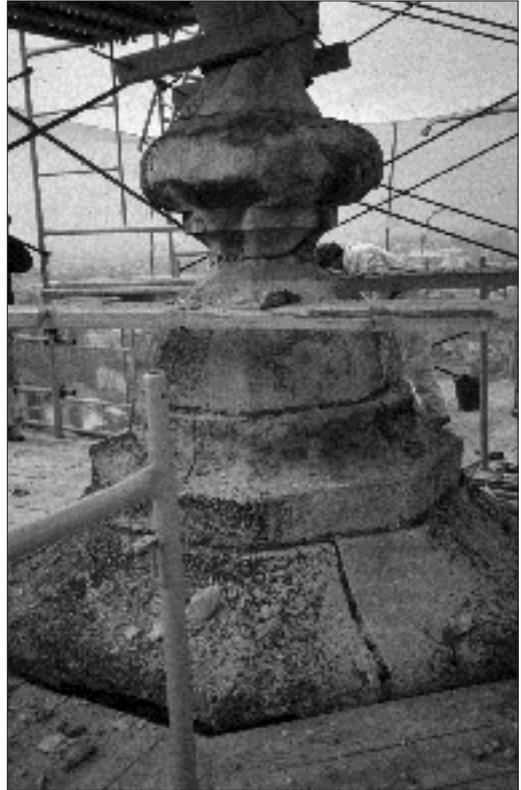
Detalle de los deterioros de la peana y del encuentro con la falsa linterna
